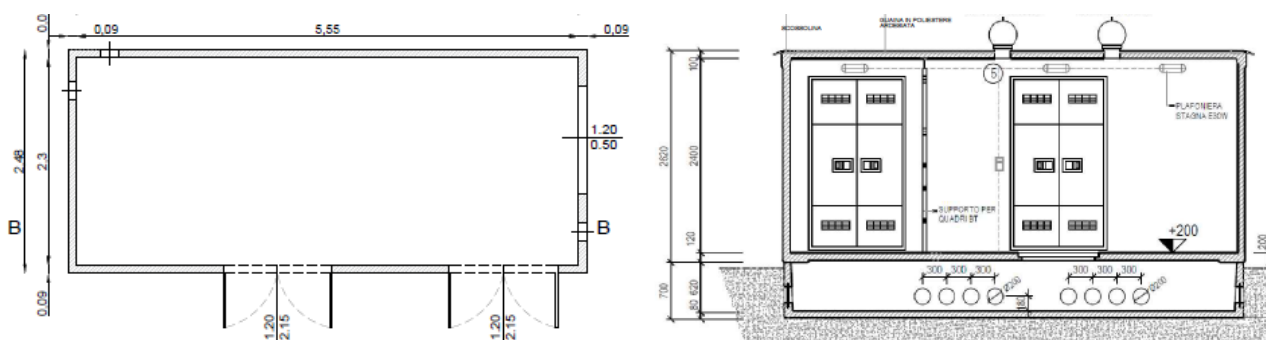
Pianta e prospetto della cabina di sezionamento
